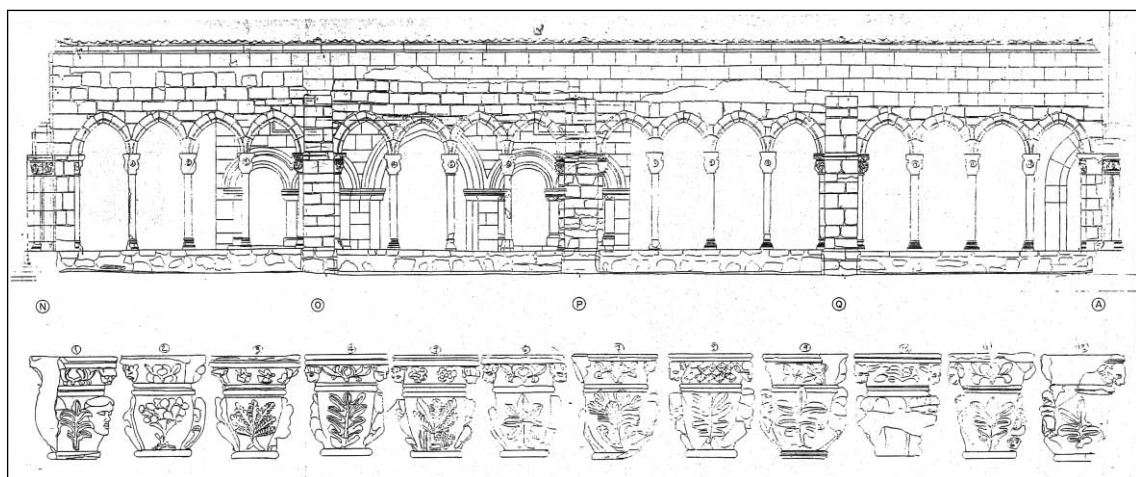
Alzado de la galería este del claustro. E. Navarro Pallarés, 1996
